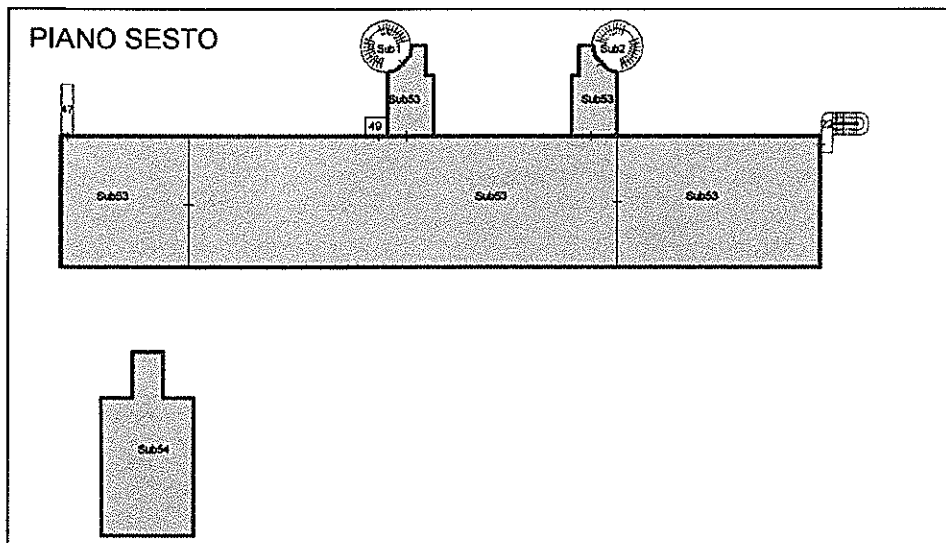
Elaborato planimetrico piano 6. Individuazione sub 53 e 54.
